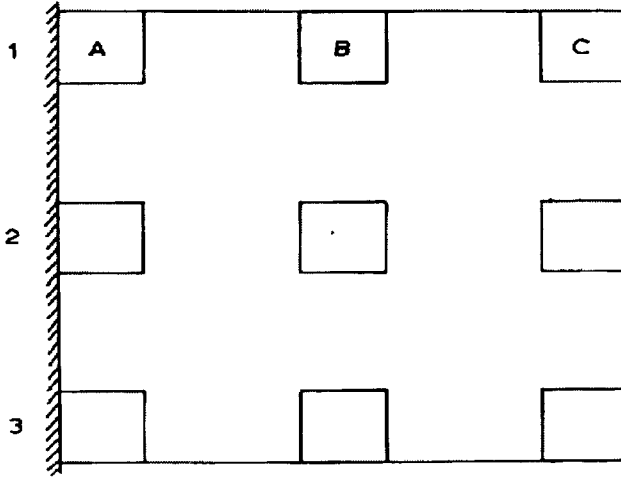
Planta de cimentación con zapatas de linderó y centrales.
